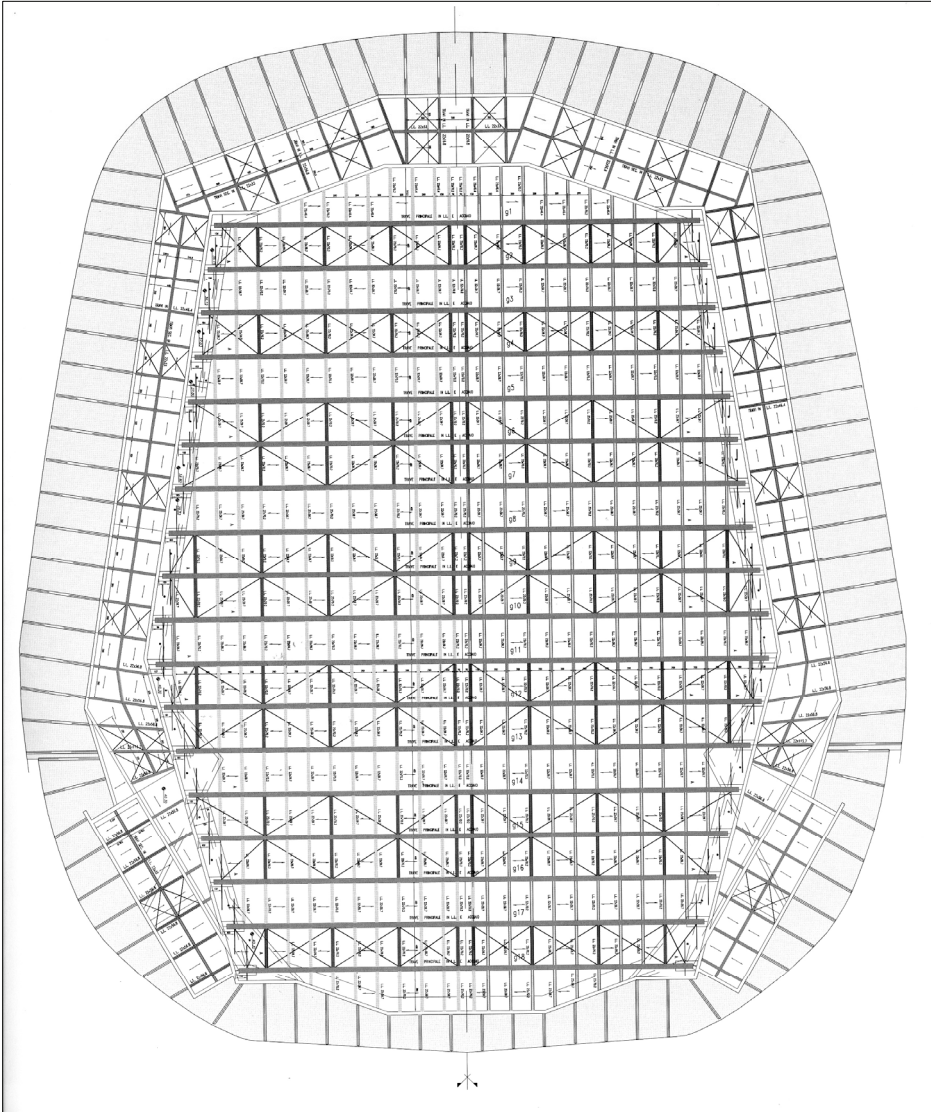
Sala 2700, pianta di carpenteria delle strutture di copertura
